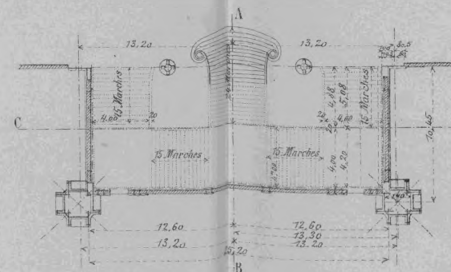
Plan de l'escalier (Côté Ecole Militaire)
